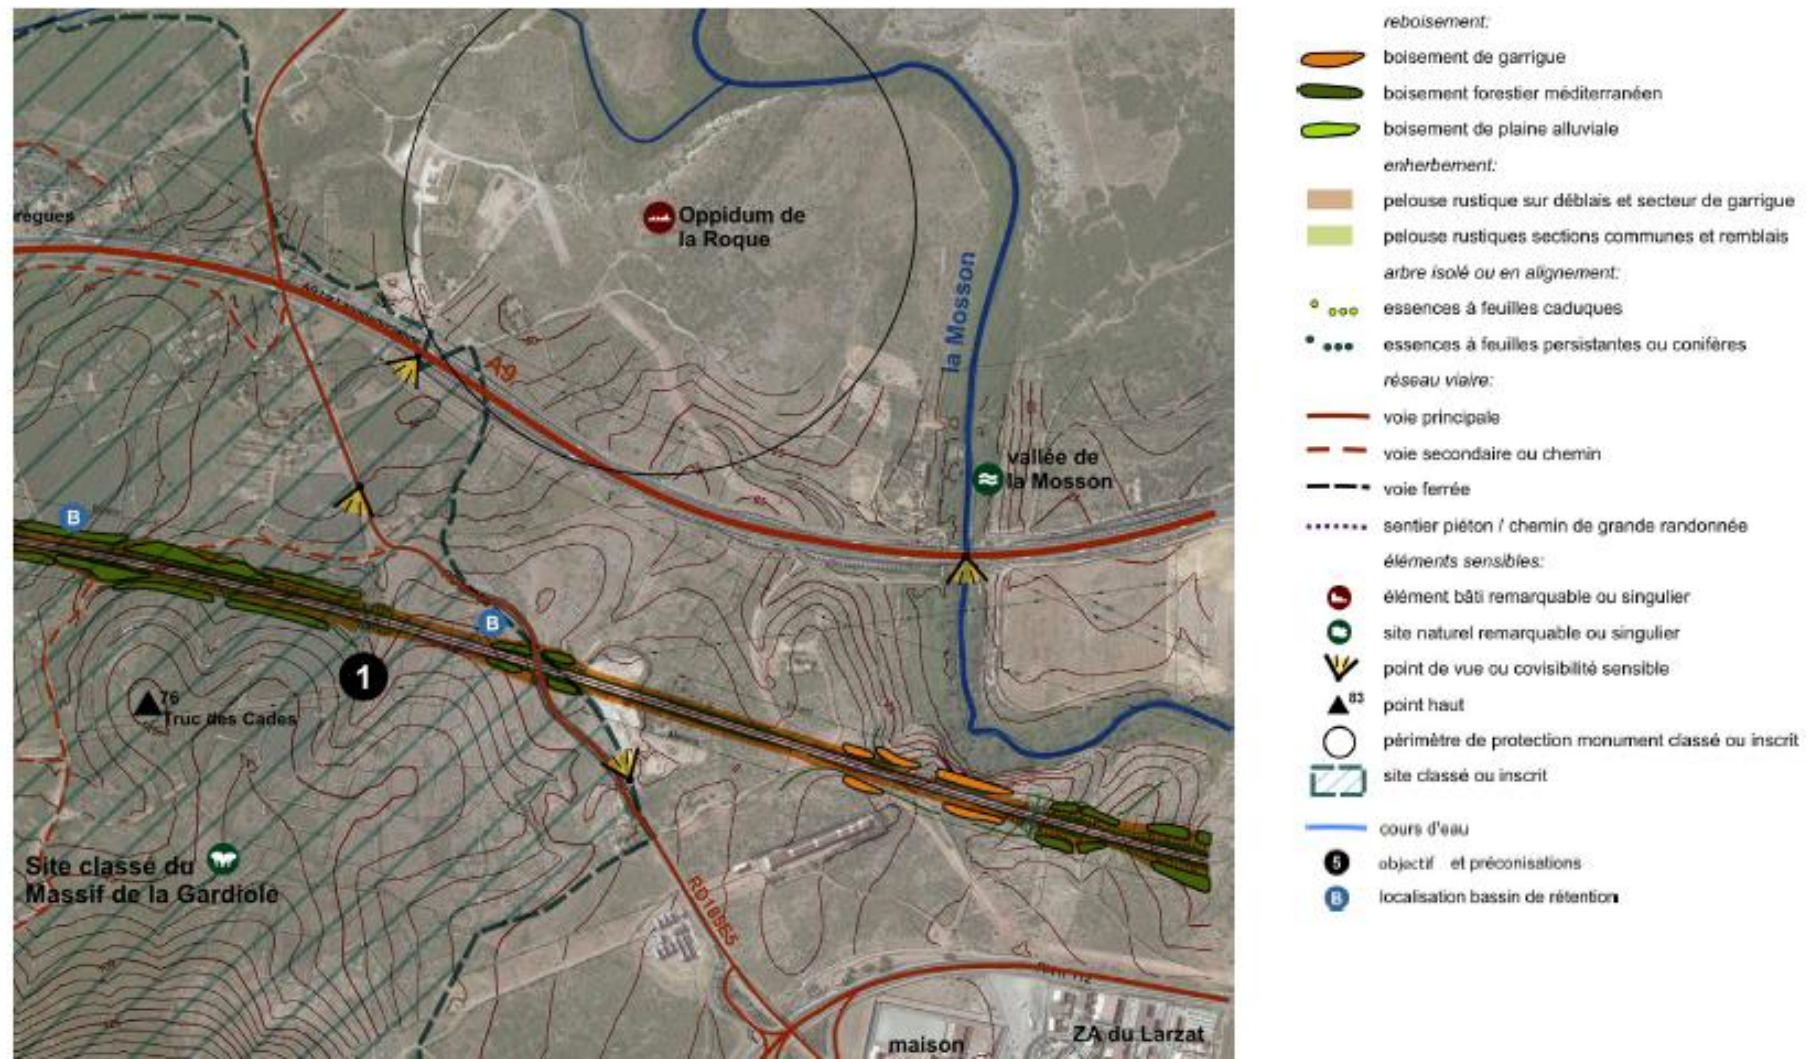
plan des mesures paysagères dans la traversée de la Gardiole (planche 3) (source : Traverses)
